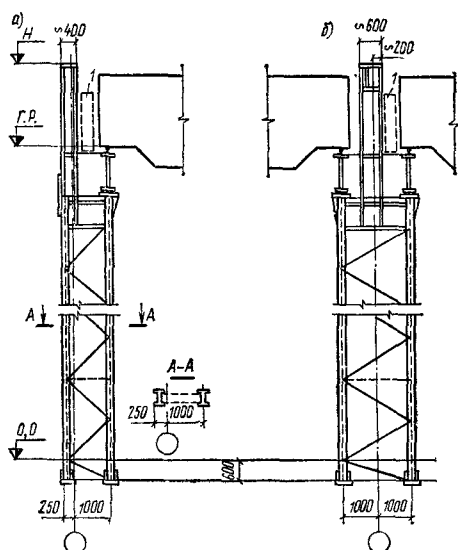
Колонны ступенчатого типа для крановых зданий с проходами вдоль подкрановых путей
